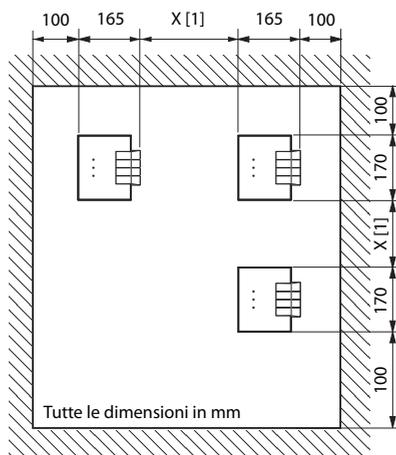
Disegno e quote per il montaggio a parete della staffa
